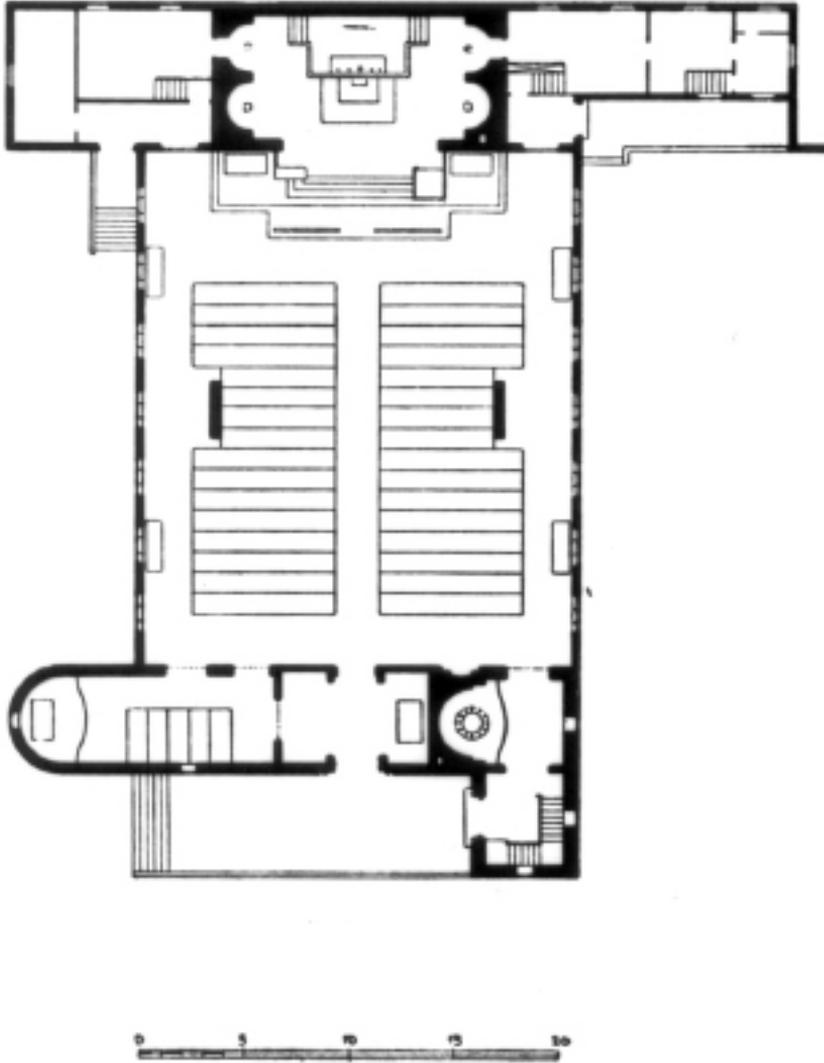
Cleve, Christkönigkirche, Grundriss, von Clemens Holzmeister, 1932/34
